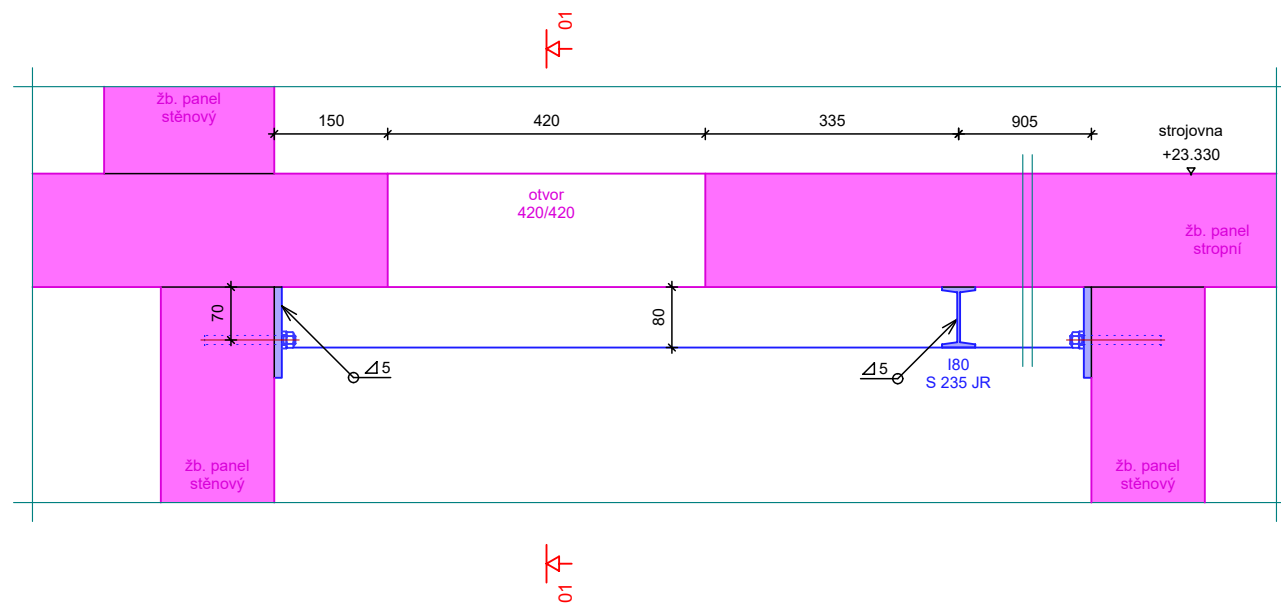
DETAIL STROPNÍCH PROSTUPŮ DO STROJOVNY M 1:10
